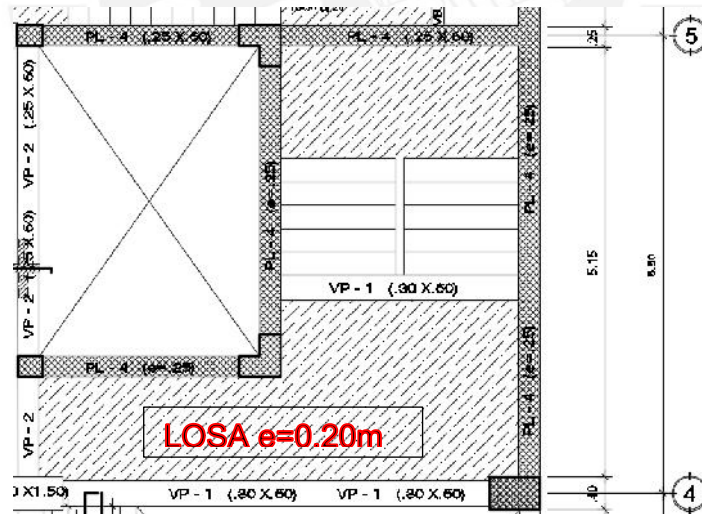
Losa maciza a analizar para el metrado de cargas
